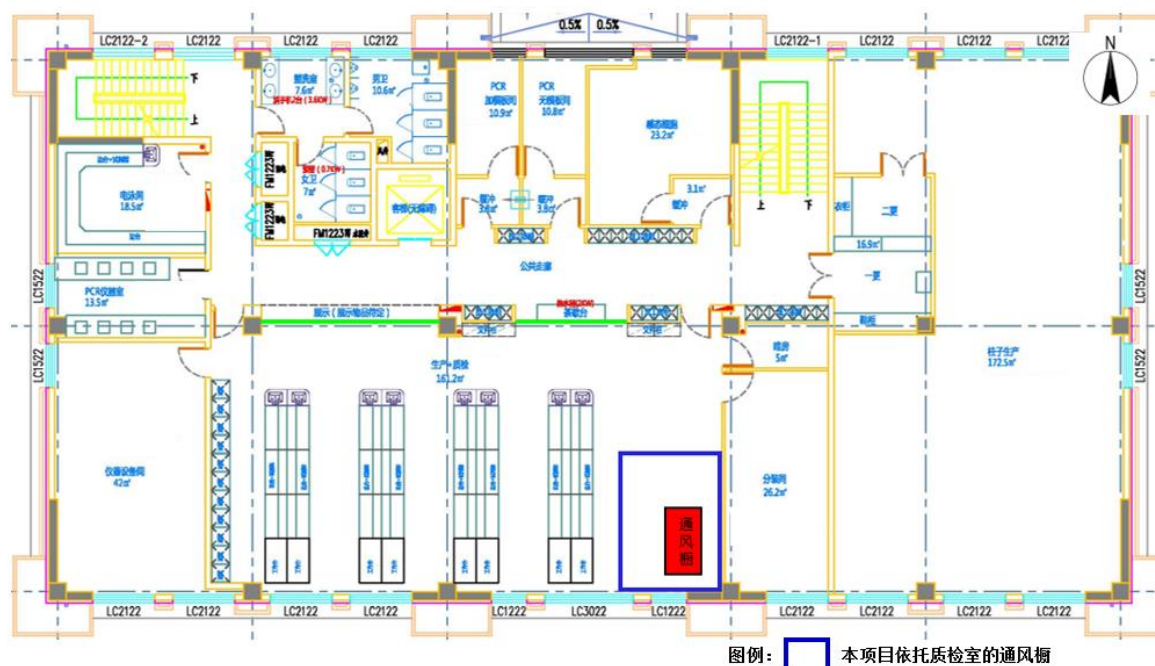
现有工程三层平面布置图（本项目依托质检室通风橱）
